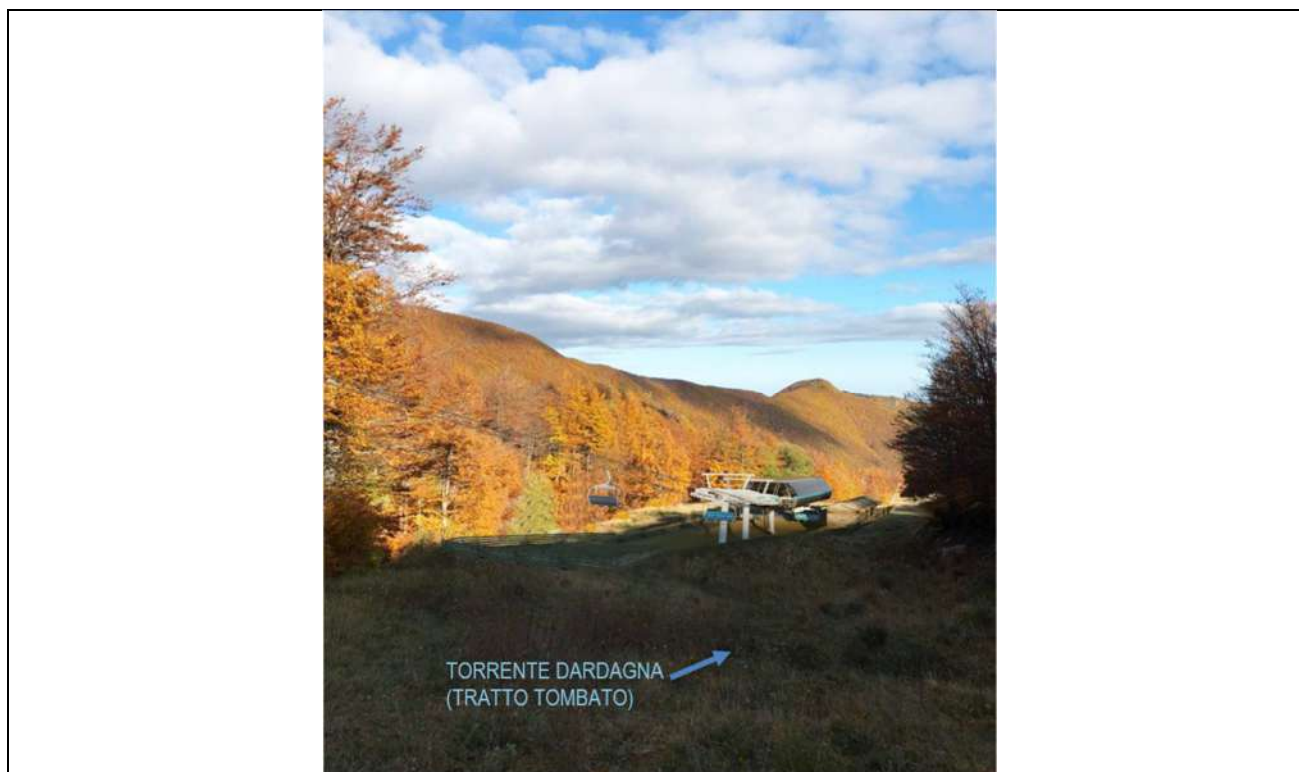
Rendering stazione di valle con vista del torrente Dardagna
